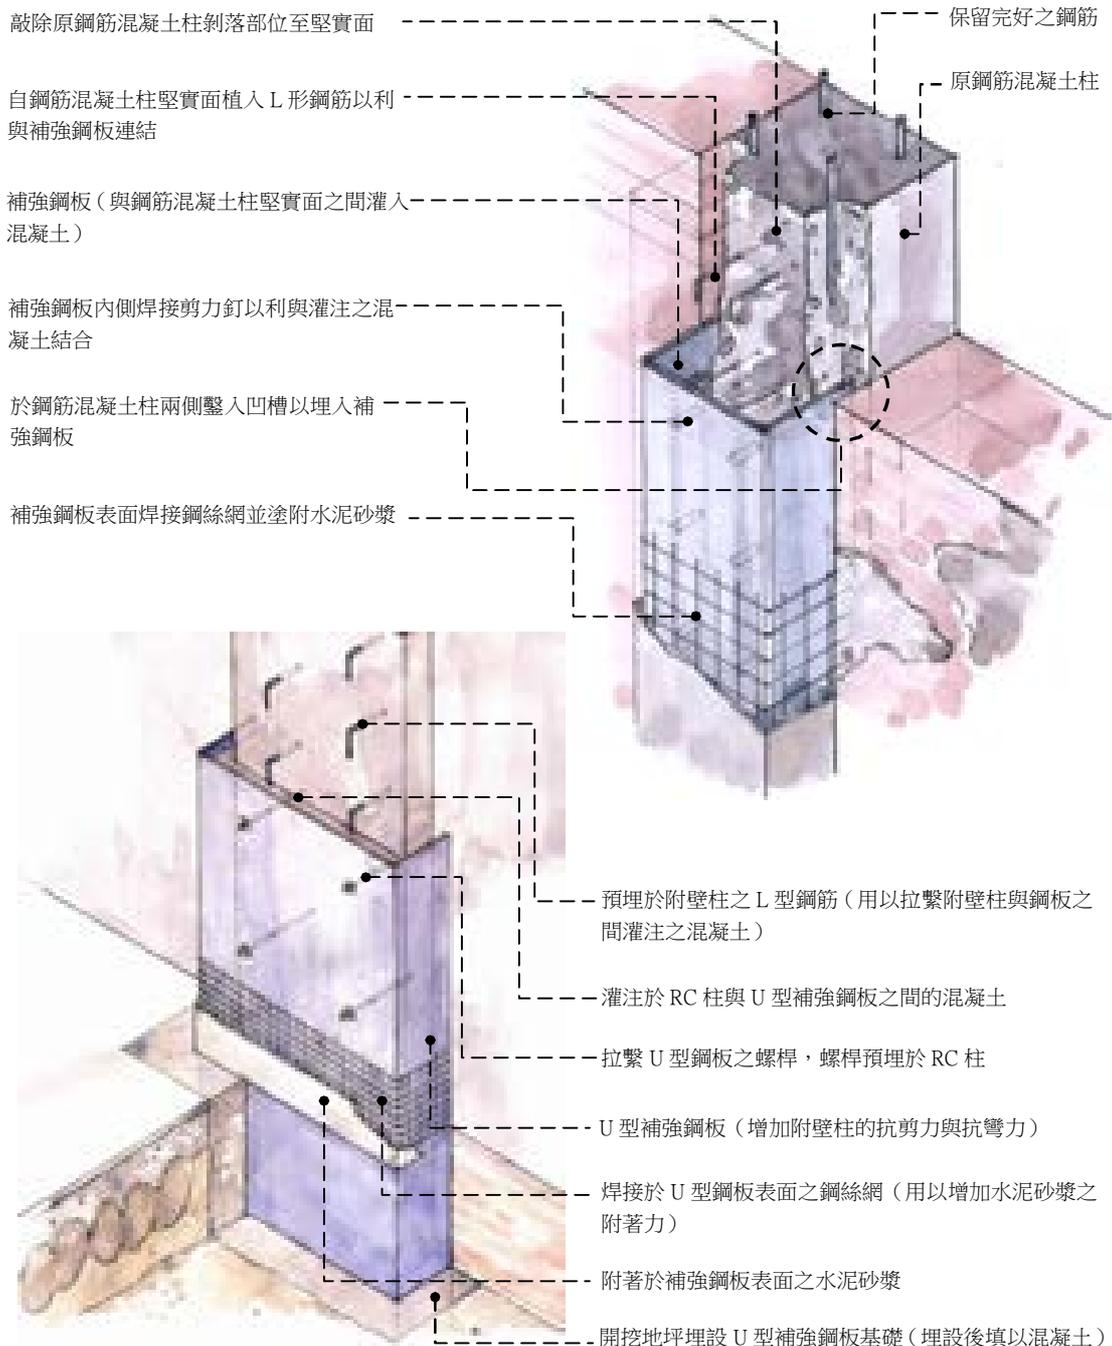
臺中市第四市場鋼筋混凝土柱補強方式建議示意圖
